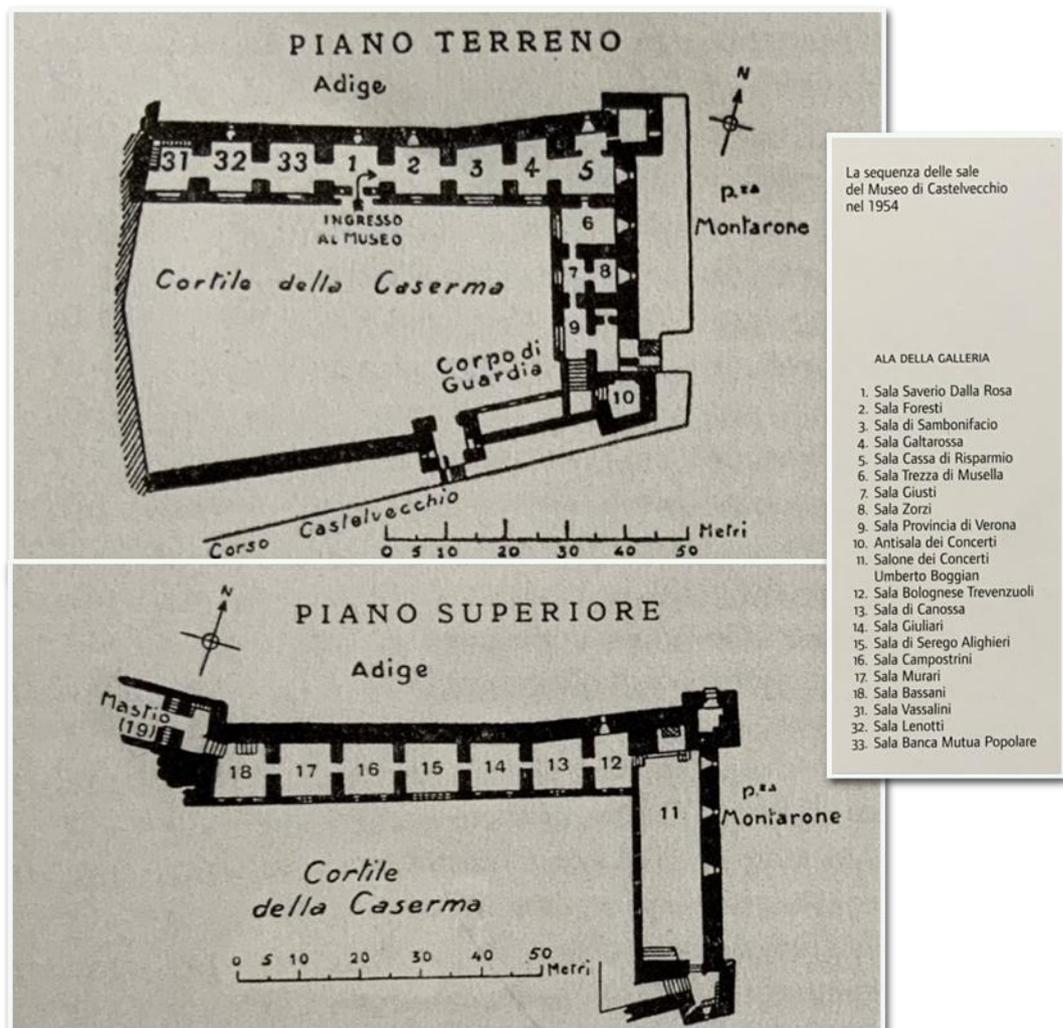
Plantas baixas do primeiro e segundo pavimentos da Ala della Galleria, em 1954
